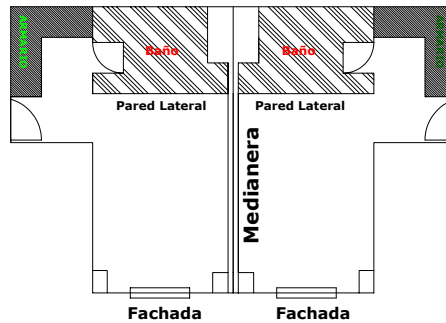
Configuración 2: Con junta de dilatación (escaleras 2-3)
